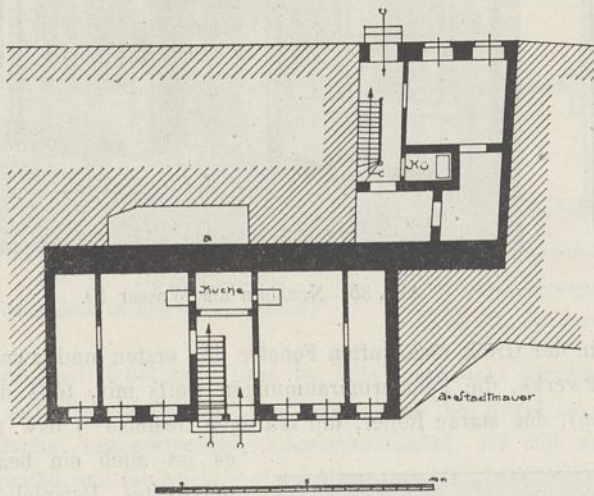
Waisenstraße 18 (unten) u. Neue Friedrichstr. 91 (oben).
